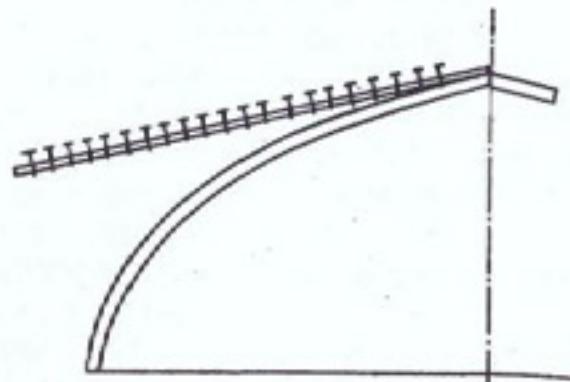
Опрессовка скорлупы рейками на гвоздях.
